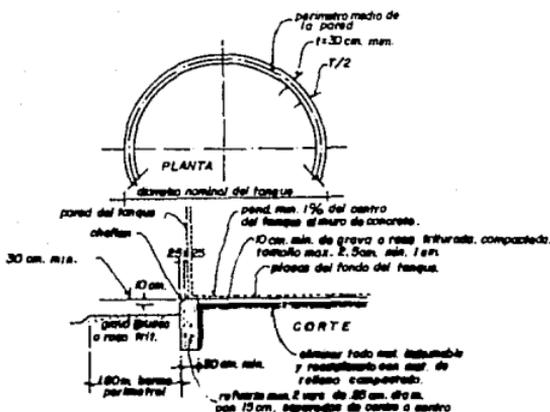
Cimentación Sobre Muro Anular de Concreto
